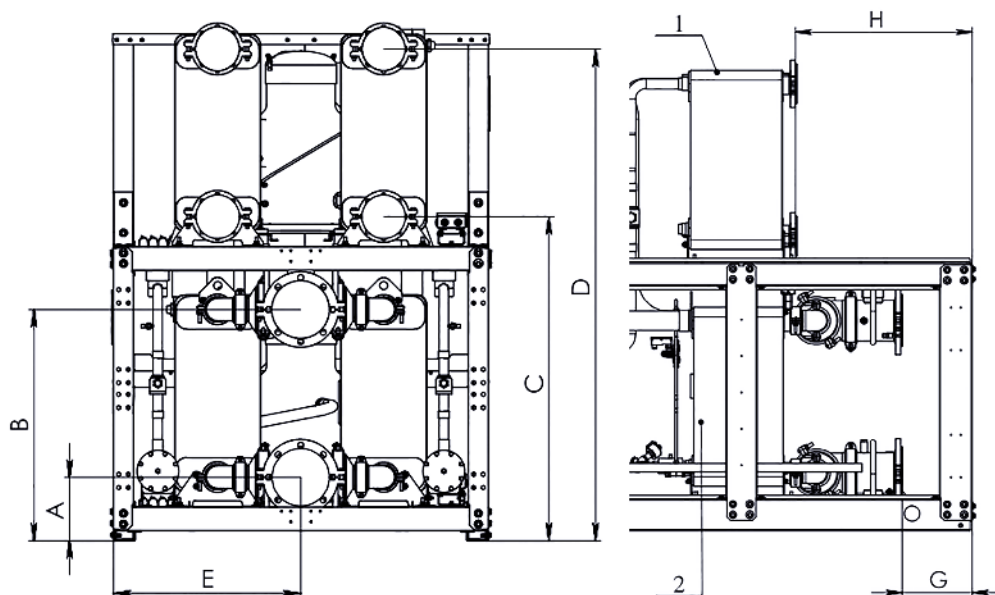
Расположение присоединительных патрубков гидравлического контура чиллеров.
